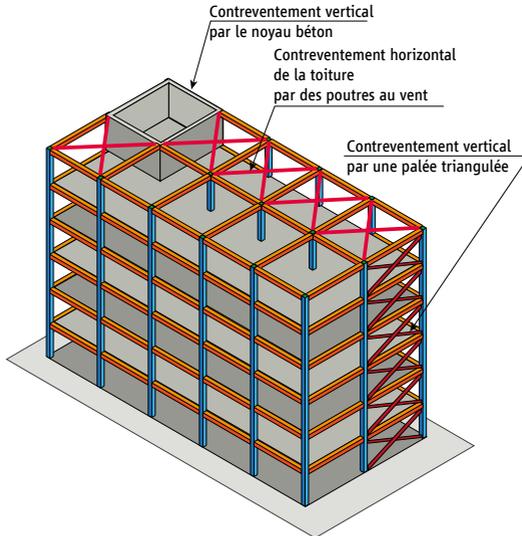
Bâtiment contreventé par les voiles du noyau en béton armé et une palée triangulée métallique
